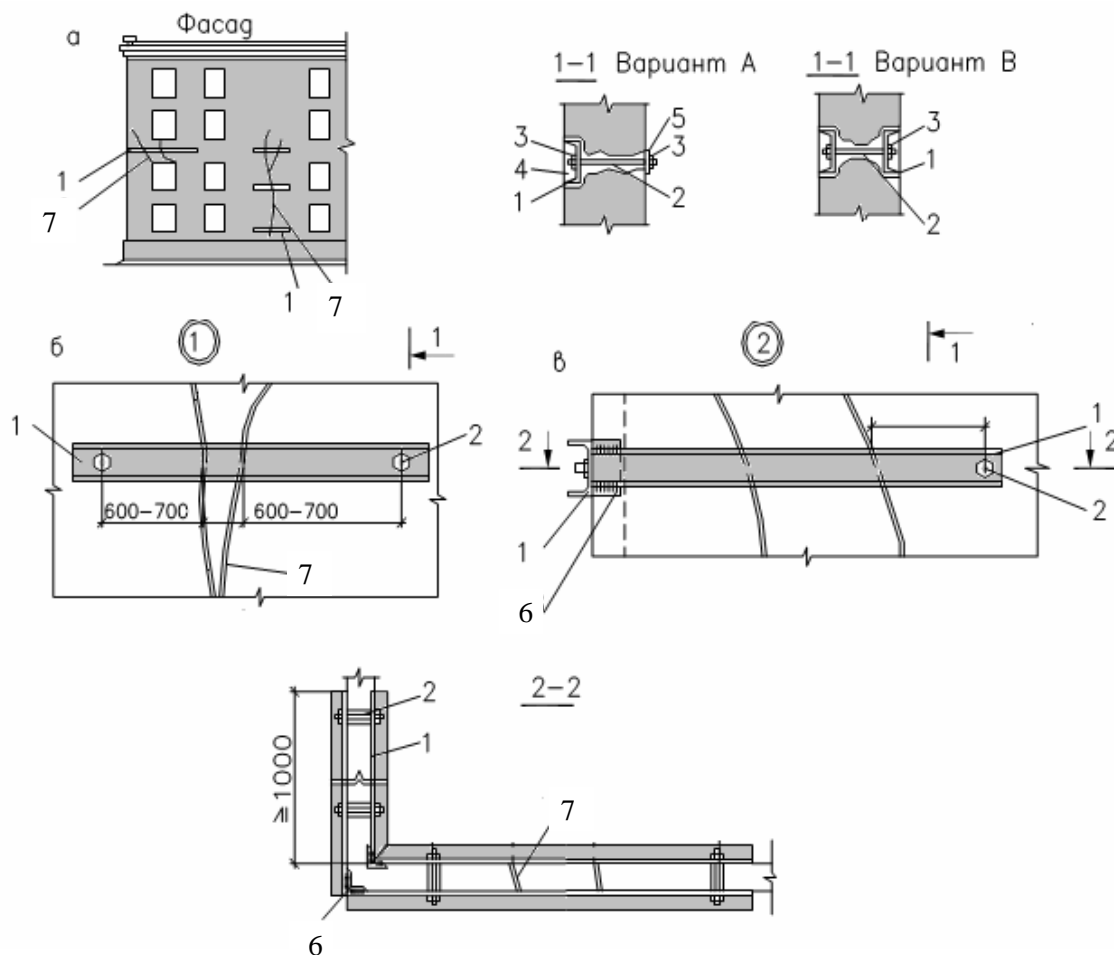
Усиление стен наладками: *а* – общий вид усиления, *б* – усиление простенка, *в* – усиление вблизи угла здания: 1 – стальная накладка, 2 – стяжной болт, 3 – гайка, 4 – штраба, 5 – опорная пластина (полоса), 6 – уголок, 7 – трещина
